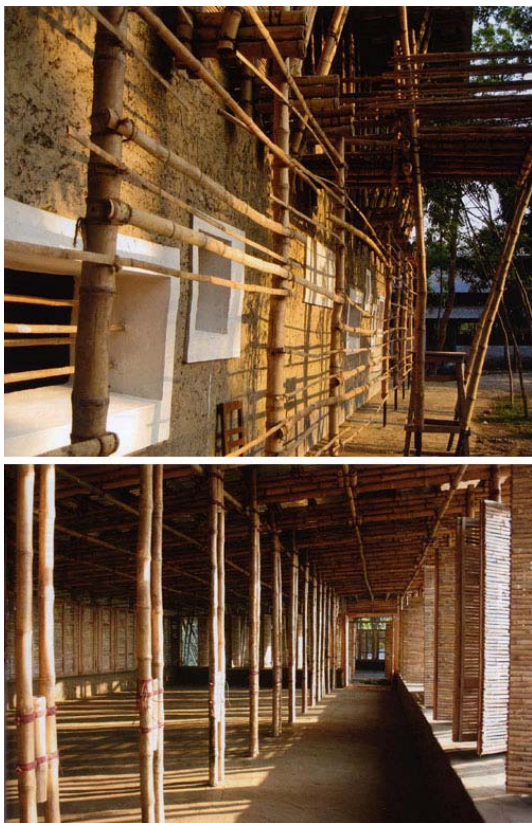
Aspecto exterior (em cima) e interior (em baixo) do edifício em construção.
